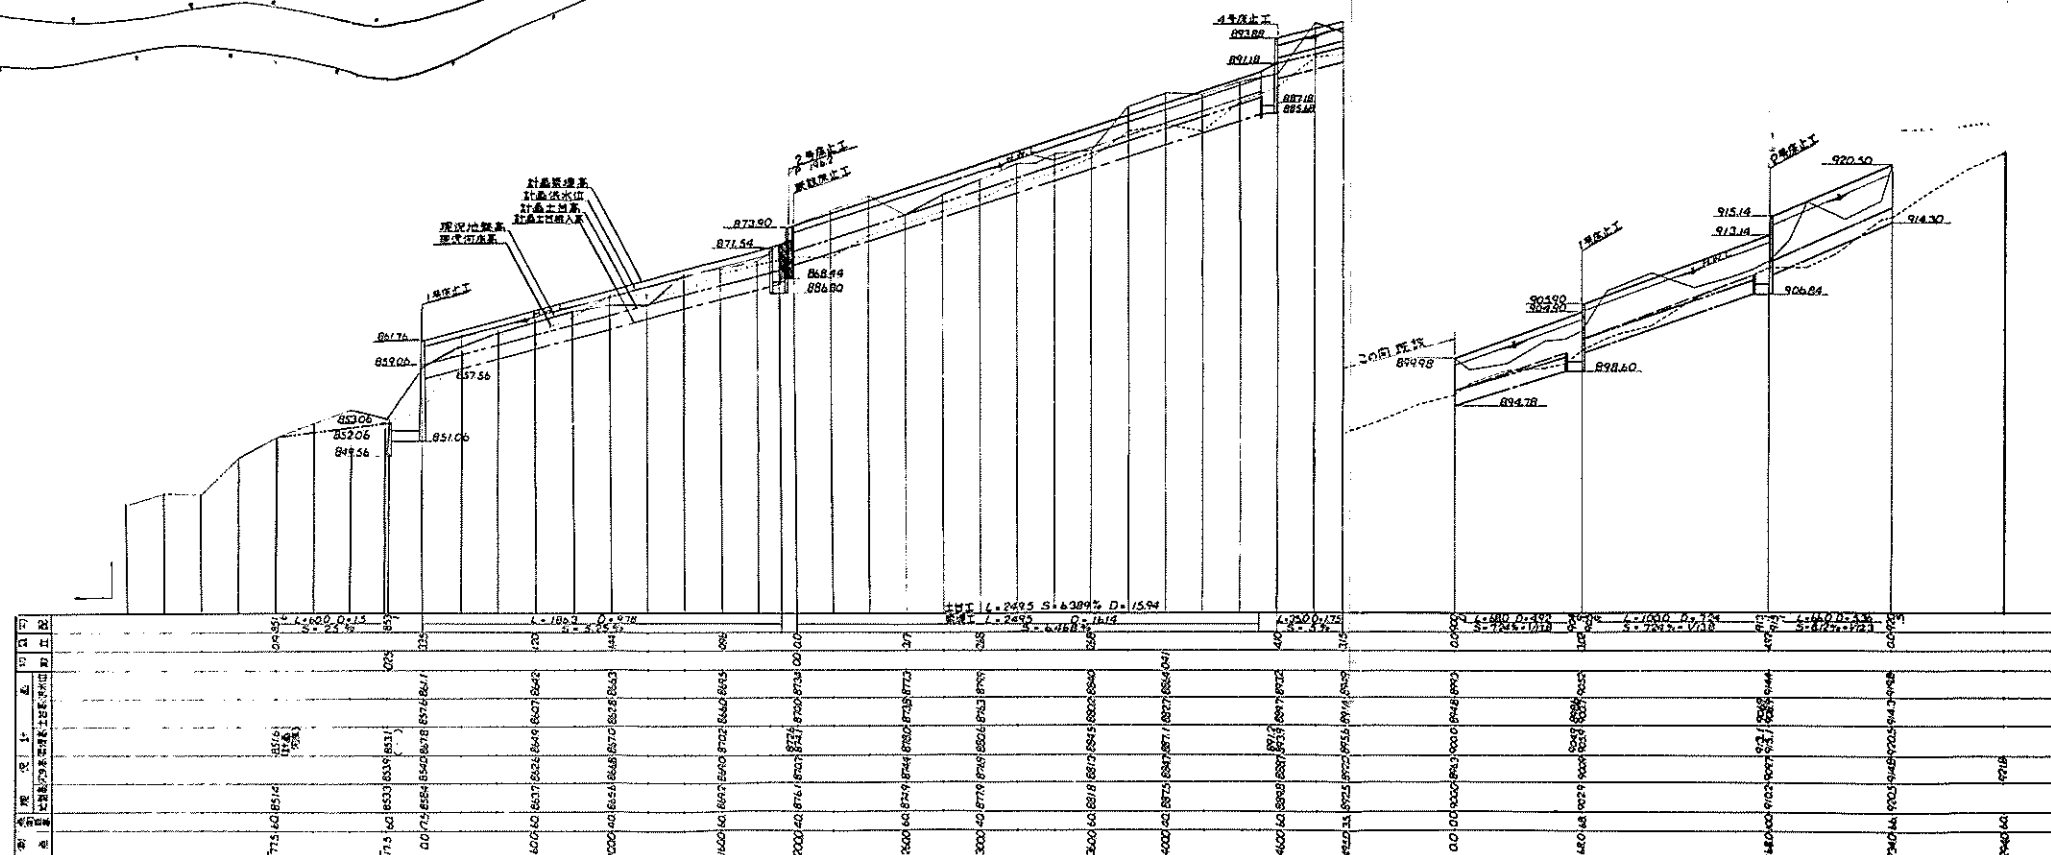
本谷川纵断面图 缩尺纵 1/800 · 横 1/4,000
